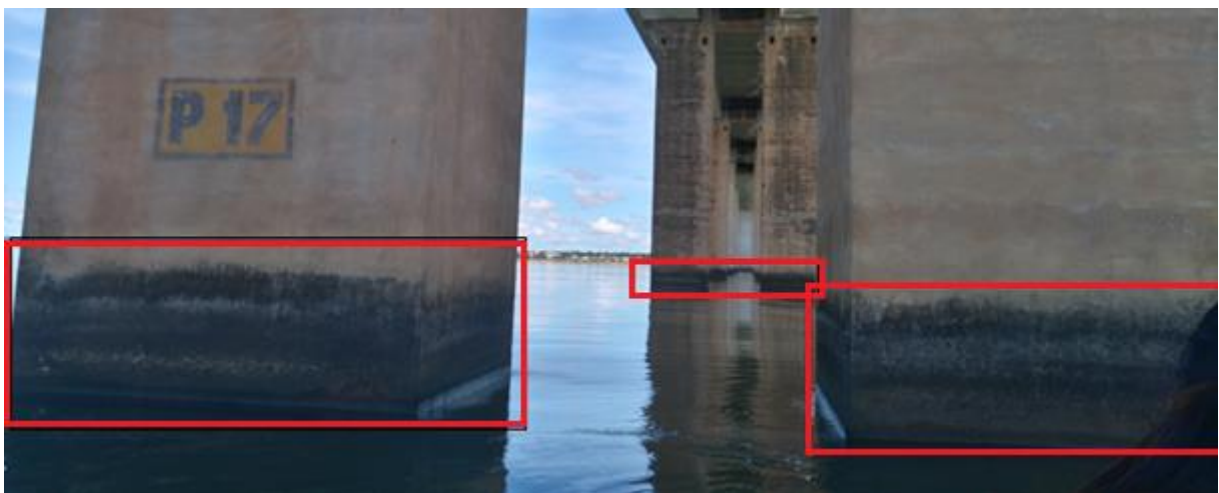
Fissuras menores que 0,2 mm de abertura.
